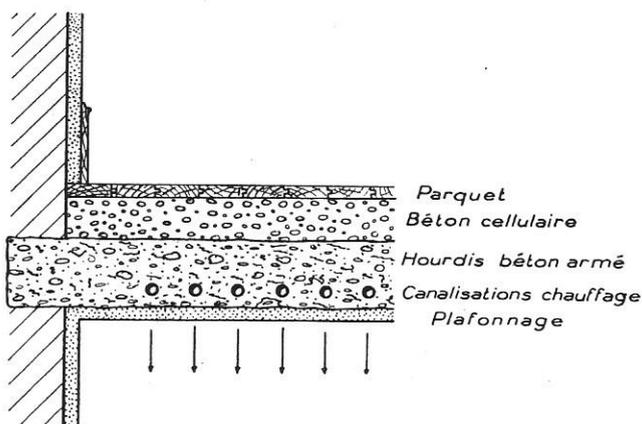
COUPE SCHÉMATIQUE D'UN HOURDIS, MONTRANT LE DISPOSITIF DU CHAUFFAGE PAR PLAFOND.
